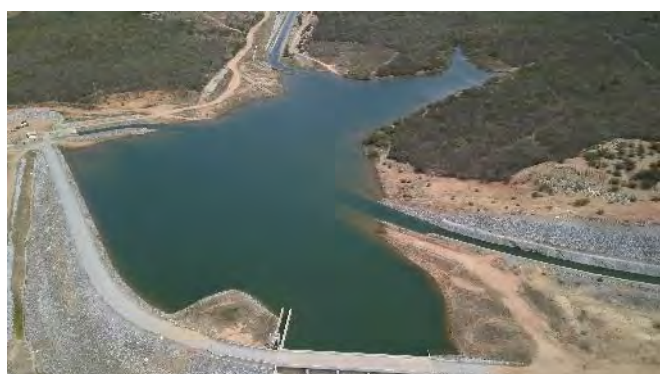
Barragem Barro Branco – Vista aérea 2
